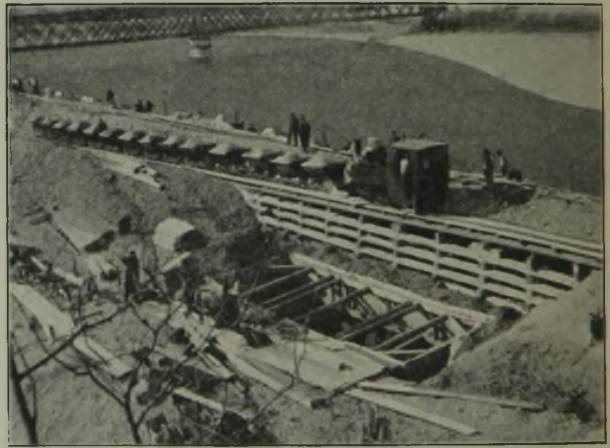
Dammschüttung an der unteren Einbruchsstelle mit Dichtungsschacht.
